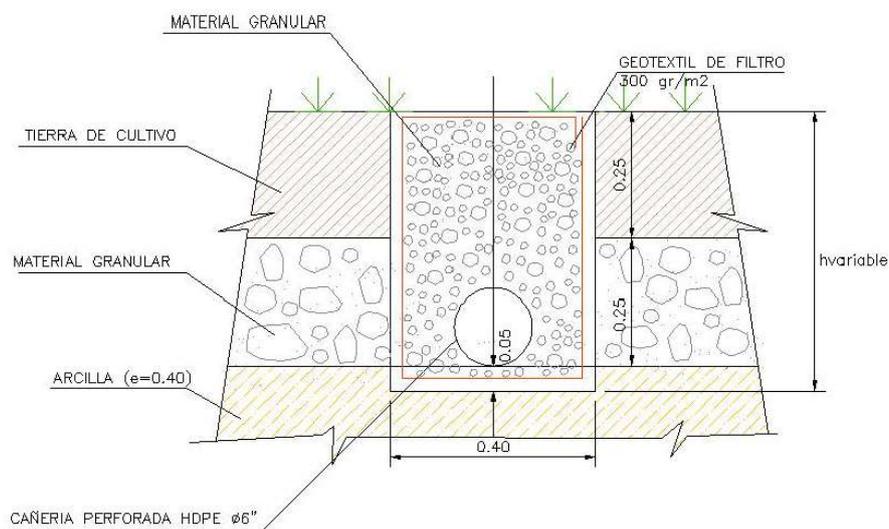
Sección transversal drenes control de escorrentía superficial
